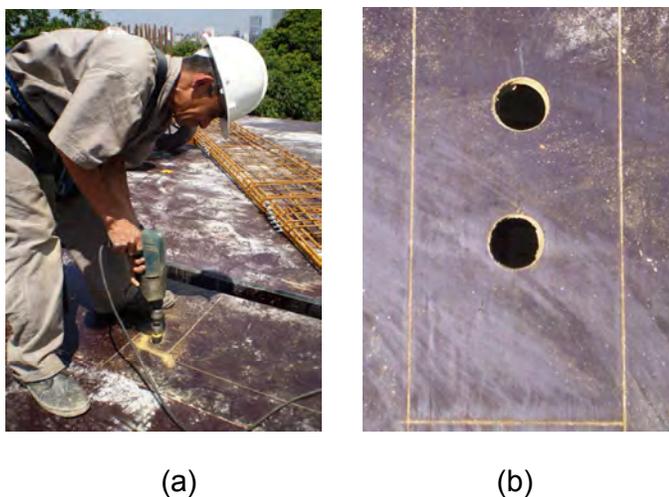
Passagem dos eletrodutos: a) funcionário executando a furação; b) molde já furado e marcação da fôrma com riscos.
